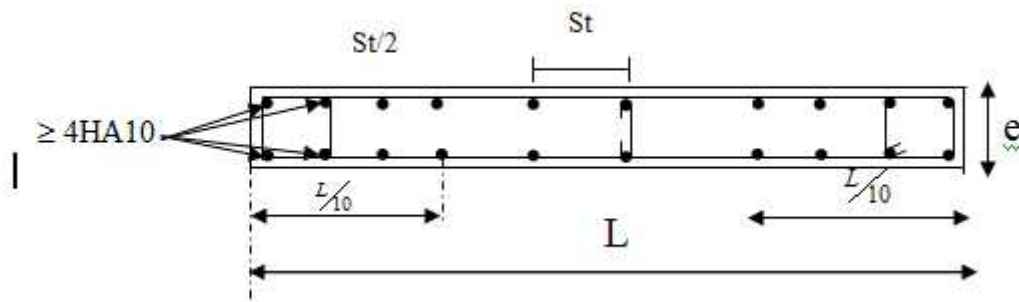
Disposition des armatures verticales dans les voiles.
